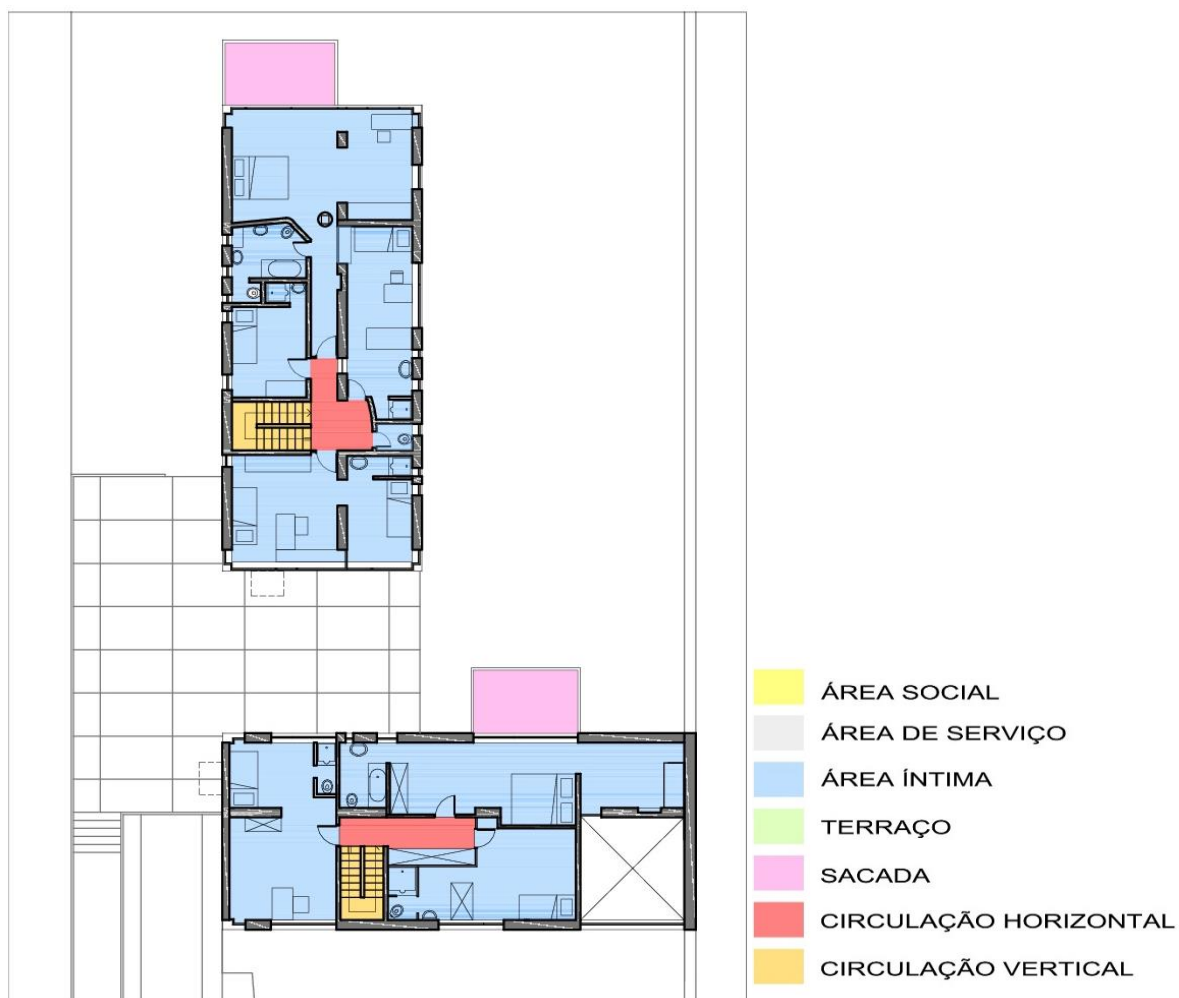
Maisons Jaoul – Zoneamentos segundo pavimento
